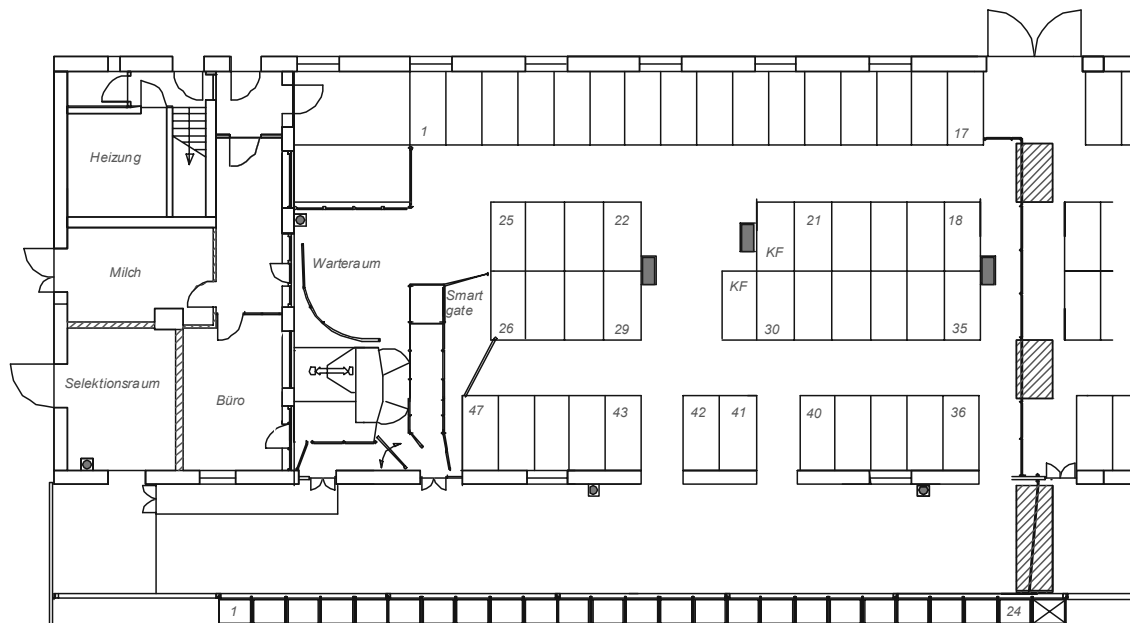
Grundriss des Stalls auf dem Betrieb Hirschau (AMS-Bereich)
